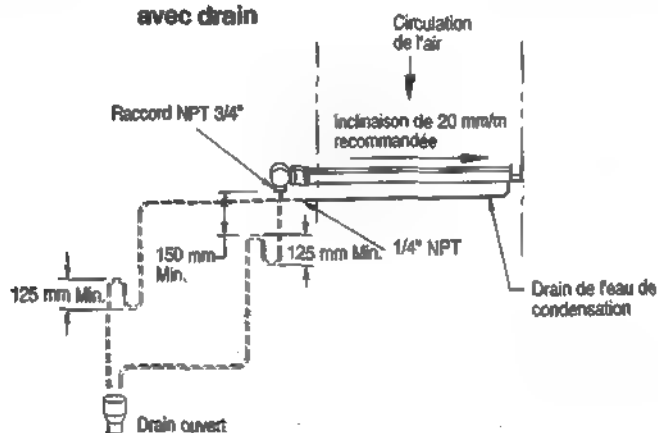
Élévation Tube avec drain (Tube Elevation with drain)
